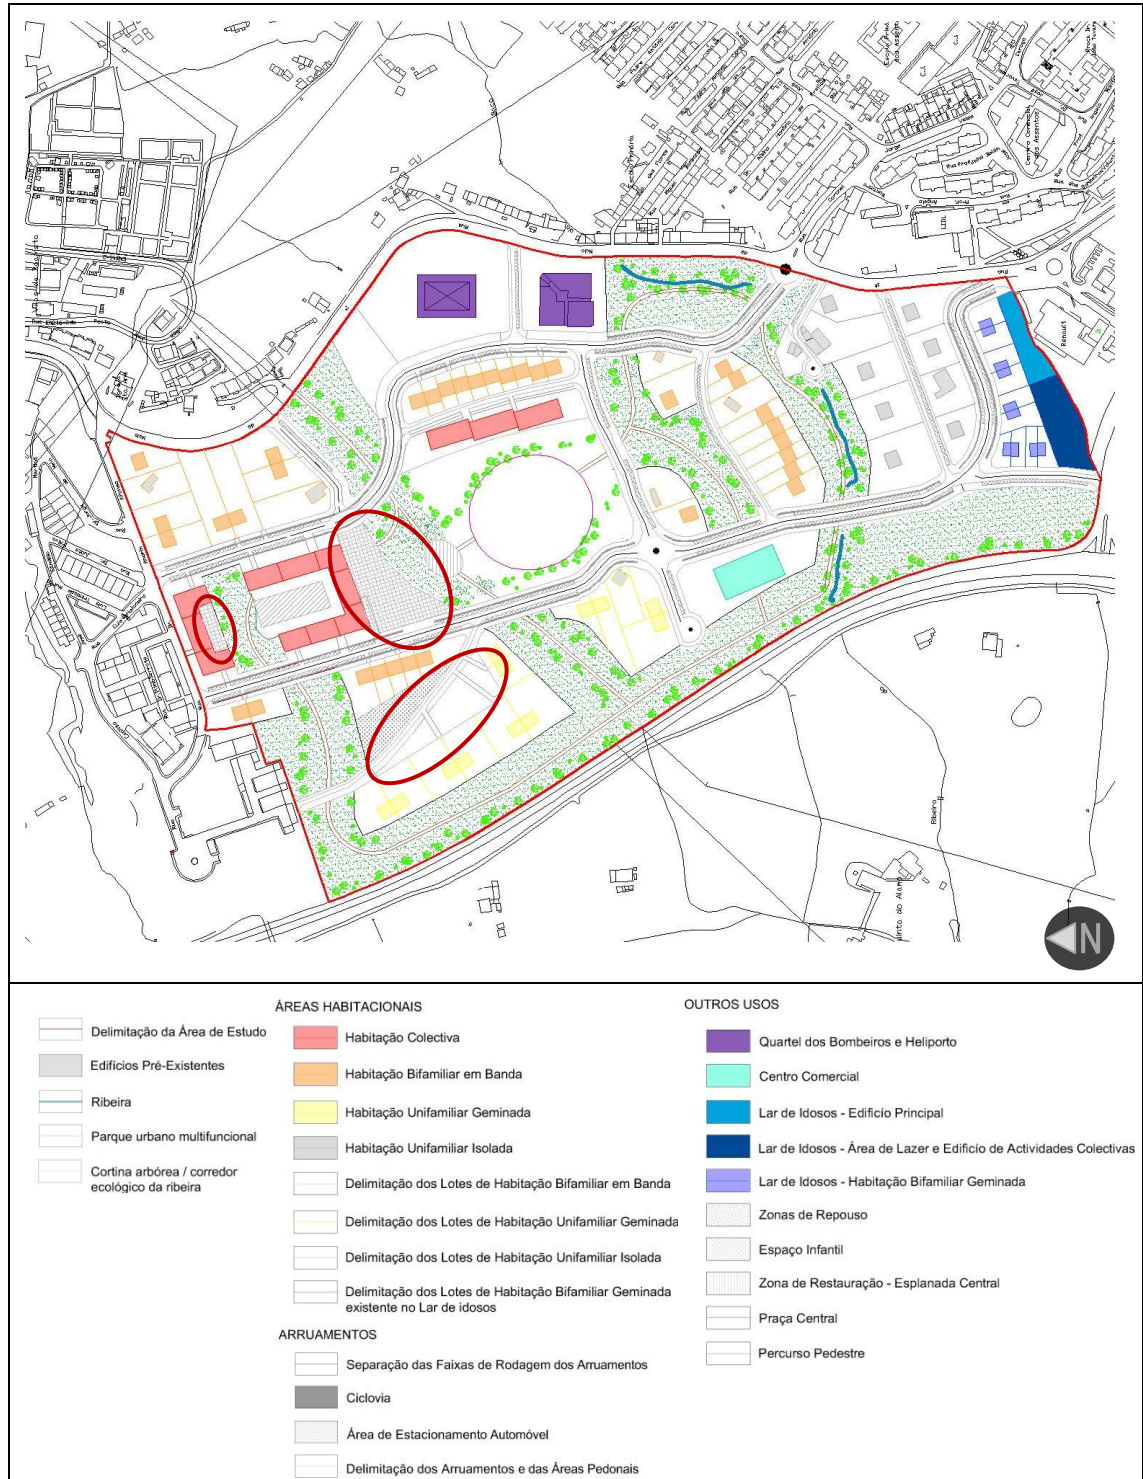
localização das Zonas de Repouso (FONTE: *autor*), [PLANTA B/20]; (Escala: gráfica)
